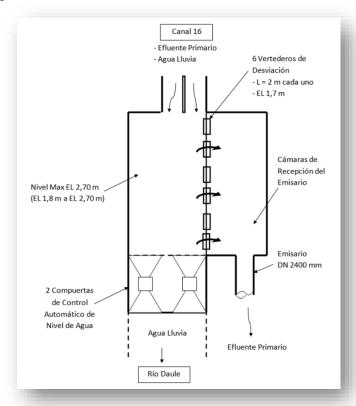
Esquema de la Estructura de Descarga del Canal 16
